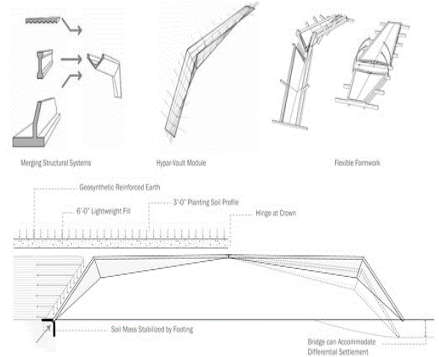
a yaban yaşamı köprüsü yerleşim planı
